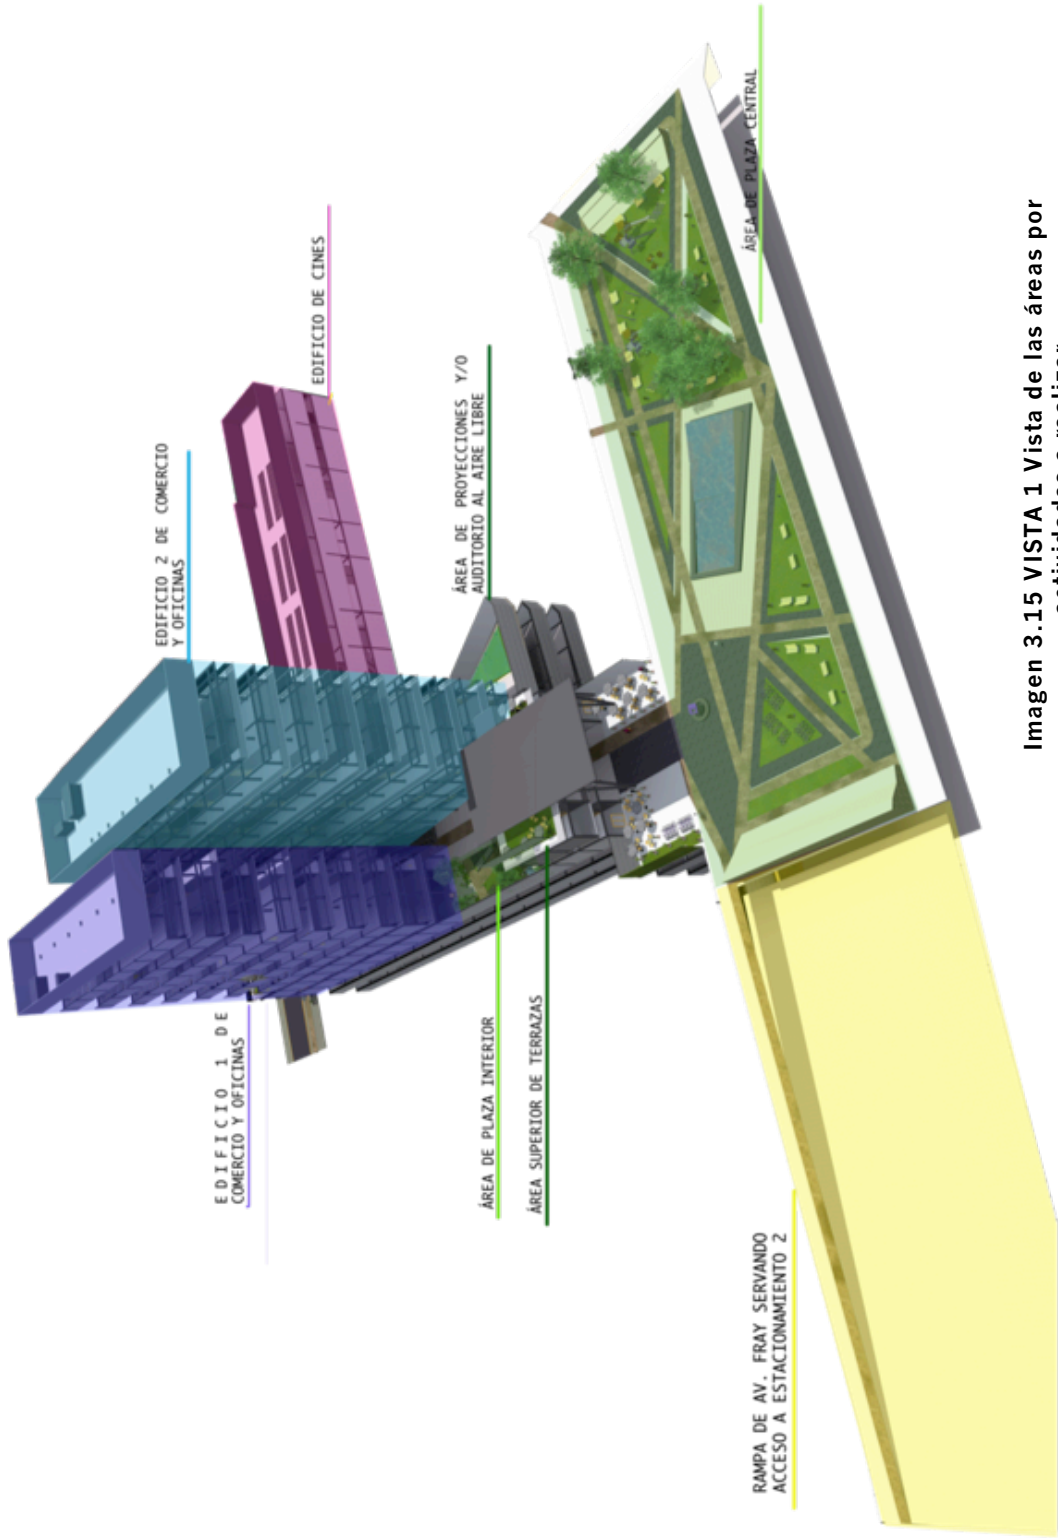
VISTA 1 Vista de las áreas por actividades a realizar.
